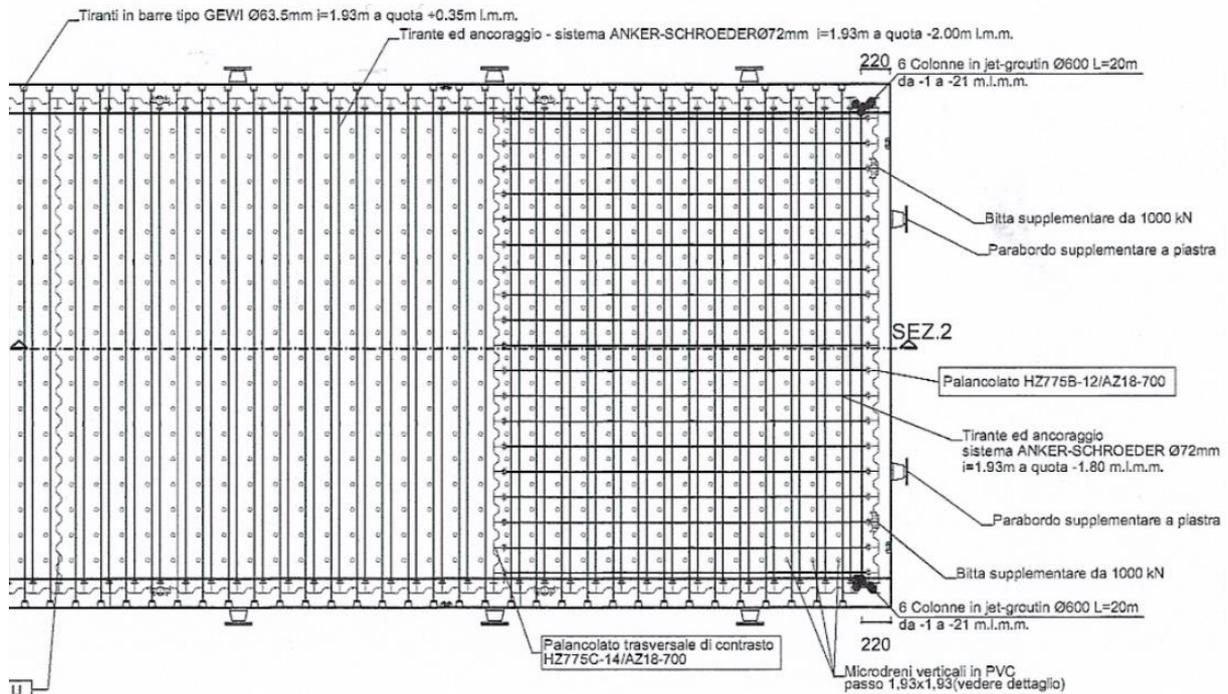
Stralcio di planimetria di dettaglio di individuazione del doppio ordine di tiranti fornita dall'Autorità Portuale del Porto di Ravenna
